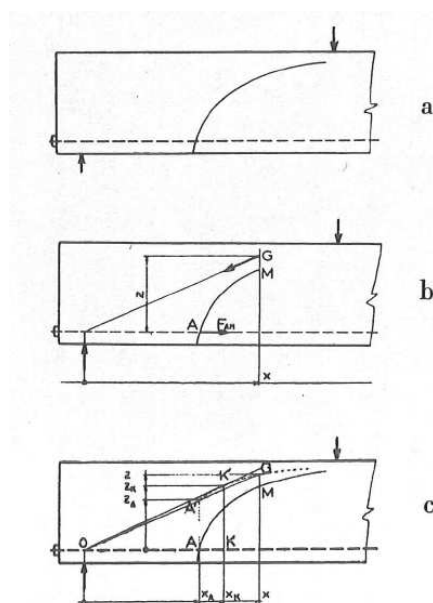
Fisuración en vigas sin armadura transversal (Robinson)
